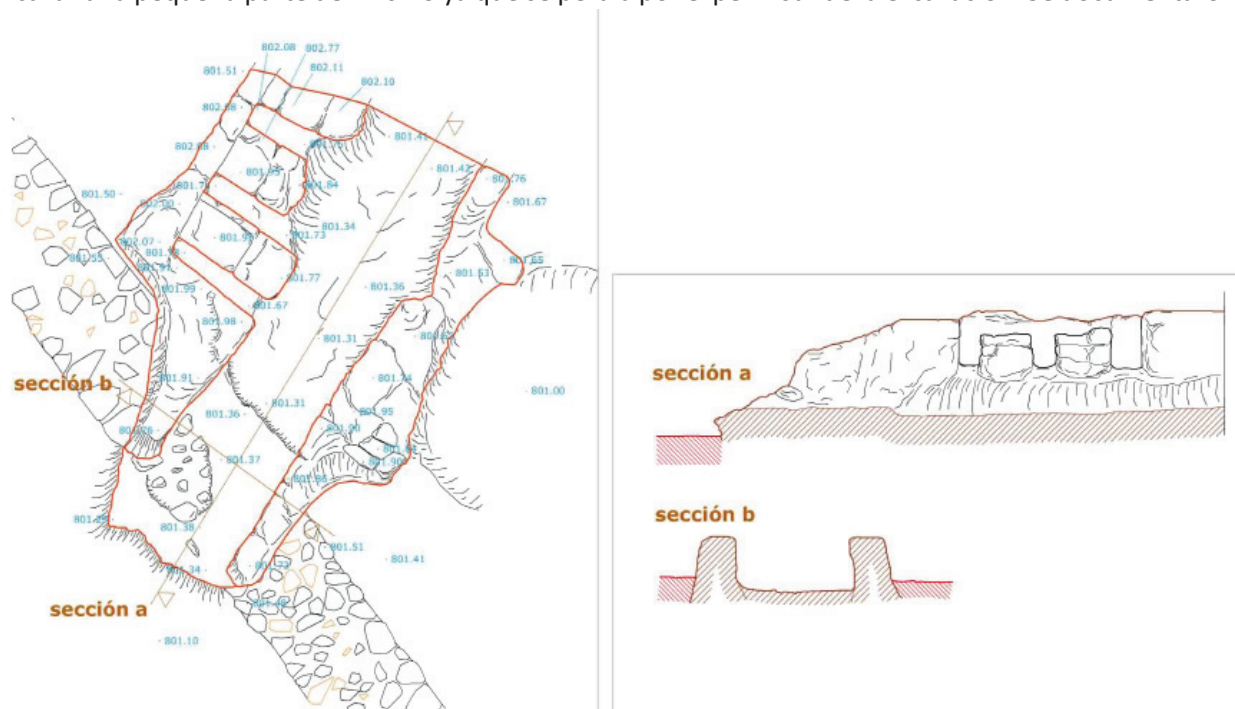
Planta y perfil del horno documentado en Villafilar.
